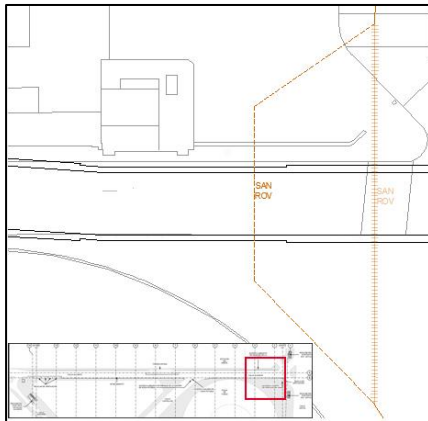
Plano de reposición SAN-ROVELLA-SR-CX-F7
